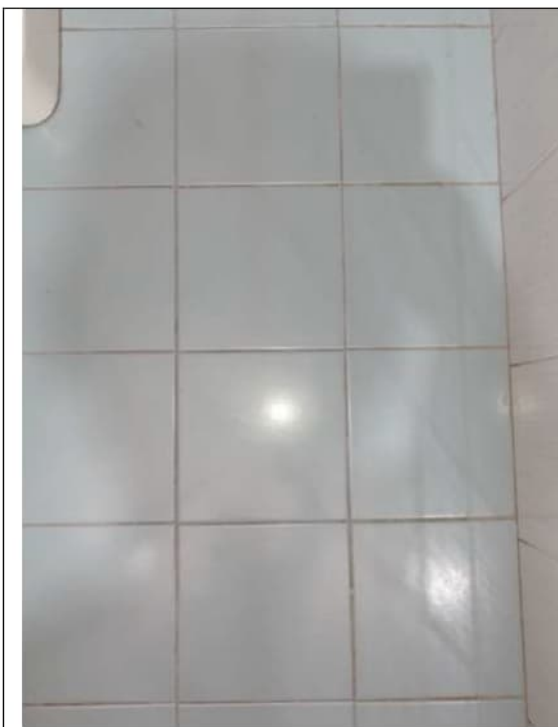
Particolare della tipologia di pavimentazione, in piastrelle di ceramica, presente nei due bagni dell'immobile, ai piani terra e primo
